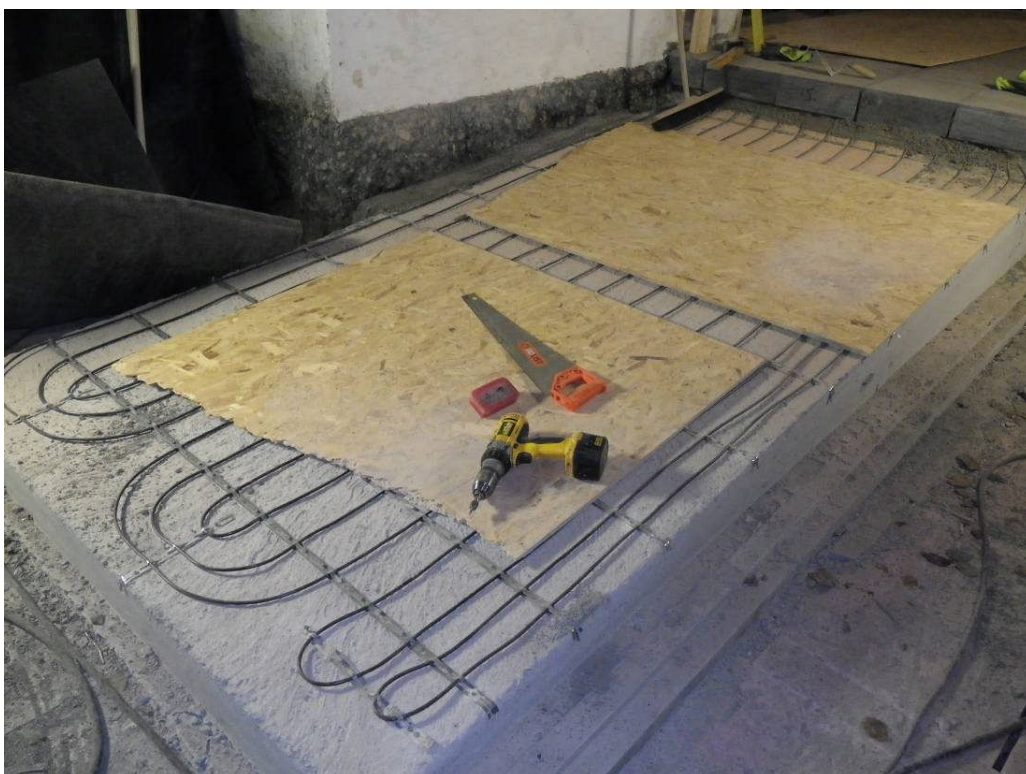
Värmeslingor gjuts in i rampens fundament. Foto Kjell Johansson
